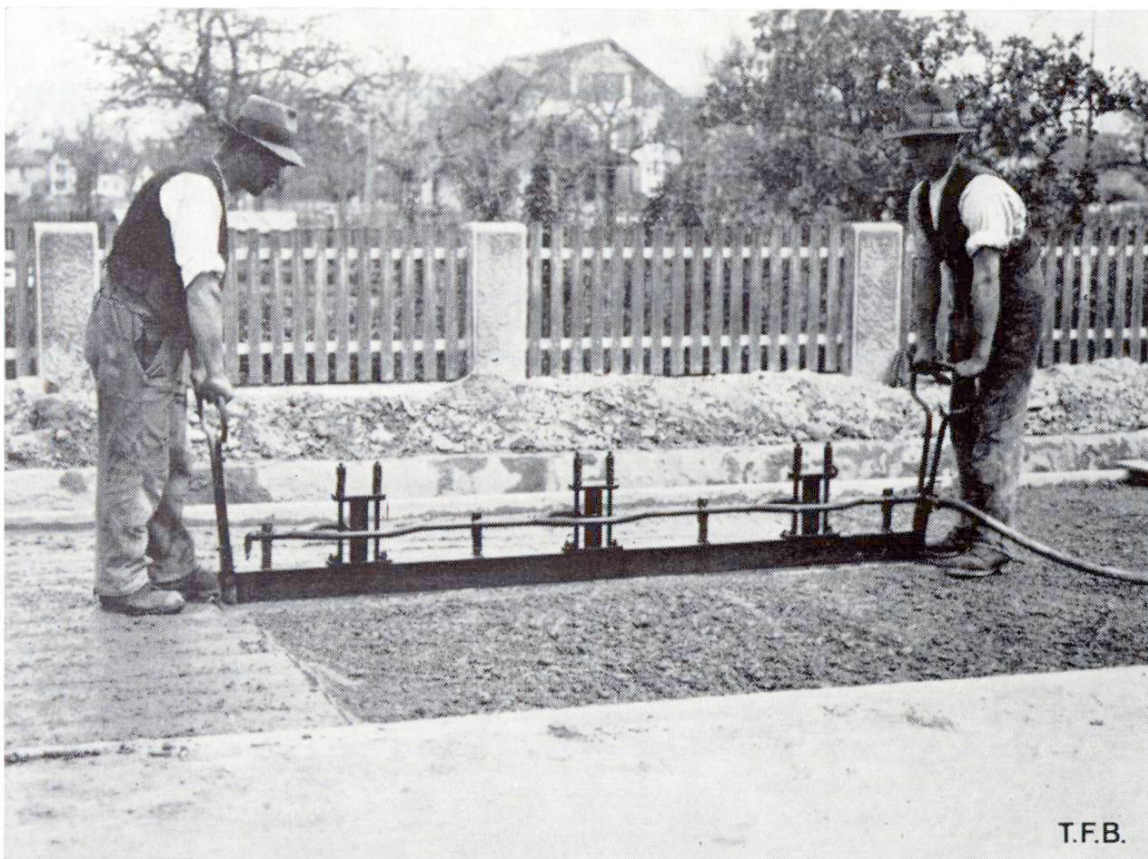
Balkenförmiger Oberflächenrüttler, angetrieben mit Pressluft beim Einsatz auf einem Betonstrassenbelag 1930.
